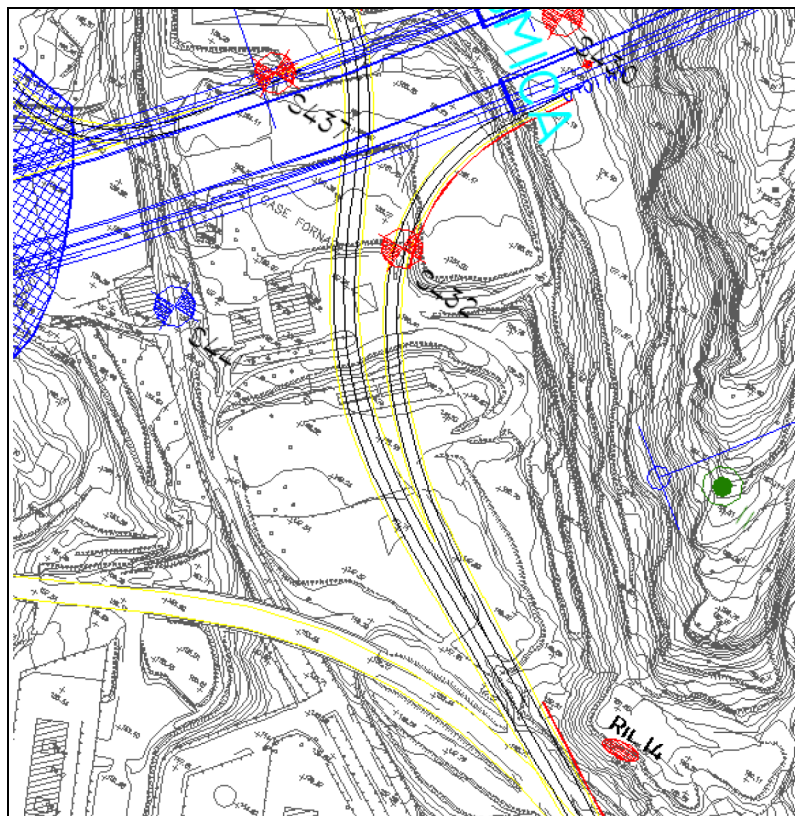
Ubicazione in planimetria dell'affioramento oggetto del rilievo geostrutturale
